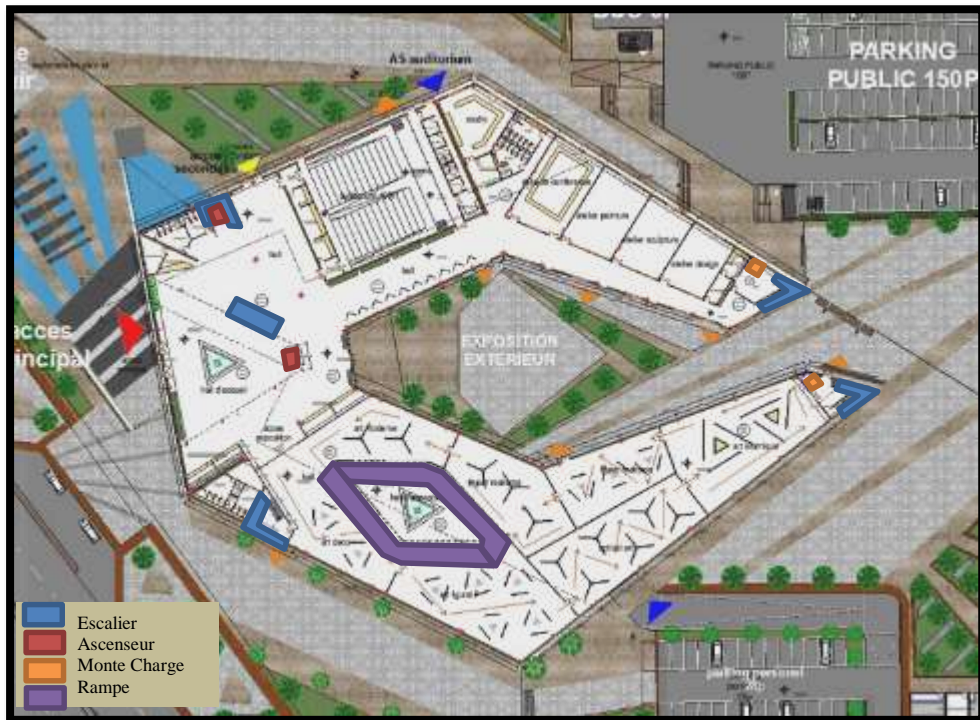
Emplacement de la circulation verticale dans le projet (Plan RDC)
